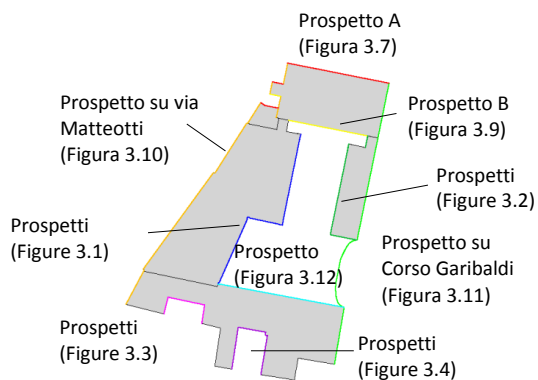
Planivolumetrico con indicazione dei prospetti
